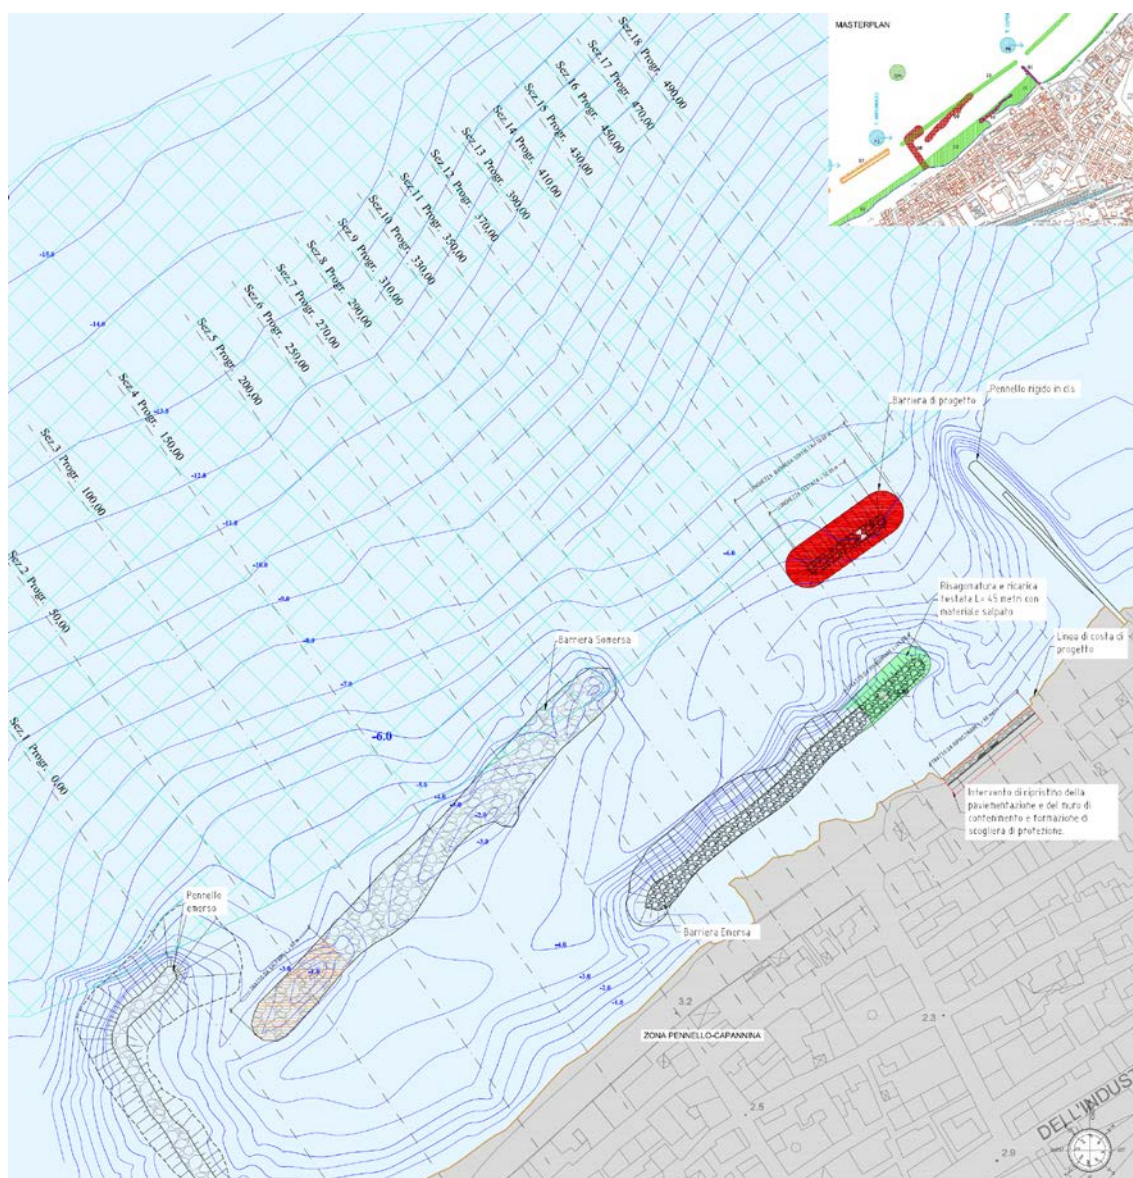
Zona oggetto di intervento – barriera emergente
